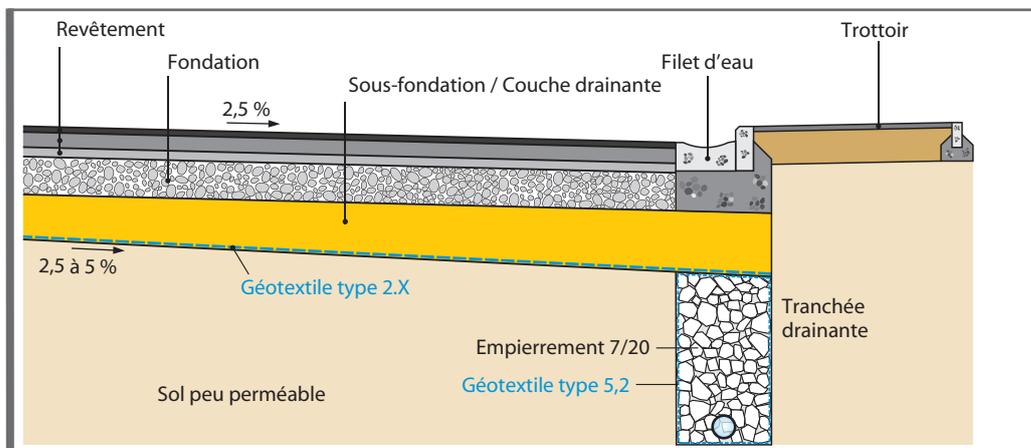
Schéma de couche drainante avec filet d'eau et tranchée drainante
